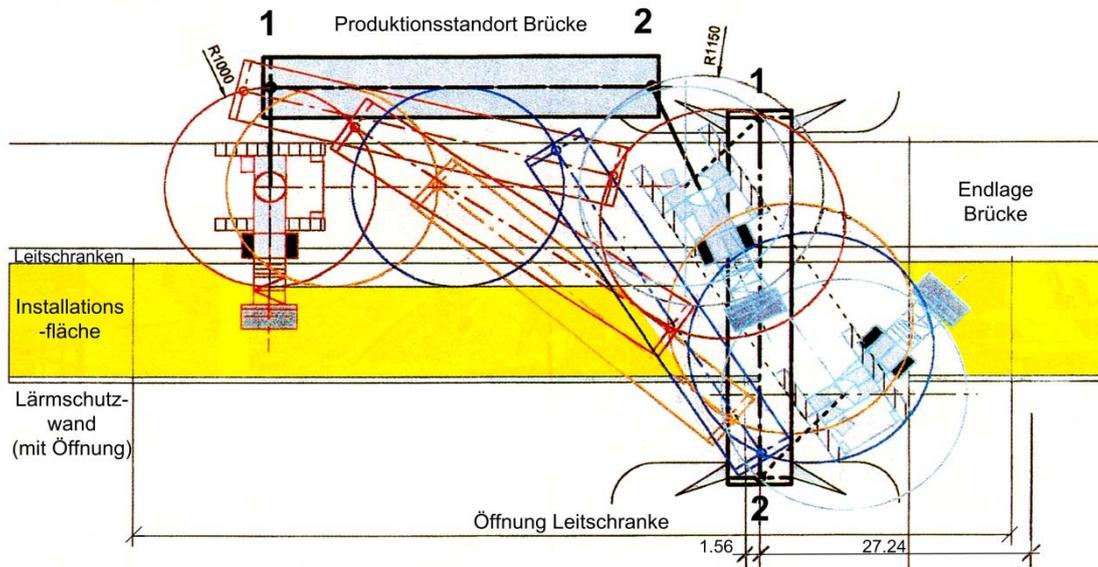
Versetzen eines Brückenelementes mit einem Raupenkran im Grundriss
